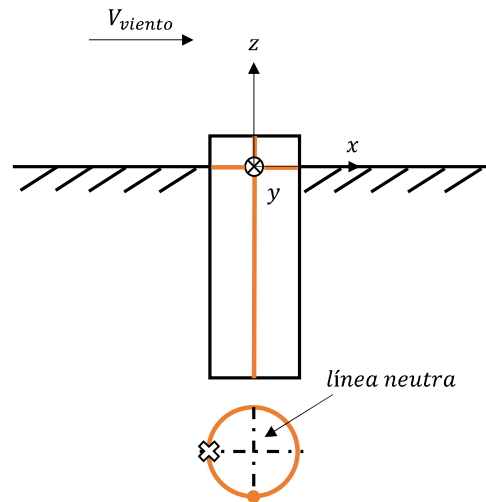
Esquema de las soldaduras en el monopilote.
